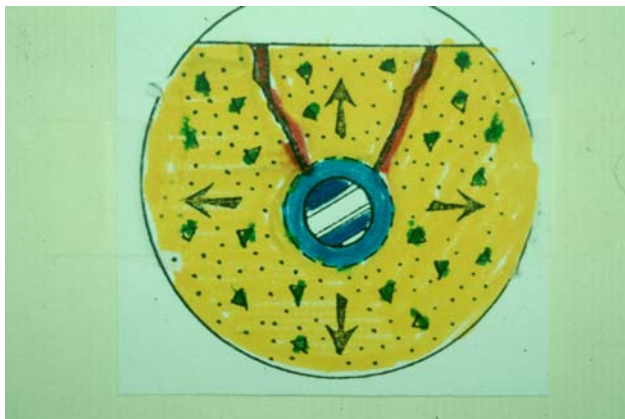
Fissuração causada pela pressão exercida pela oxidação da armadura.
